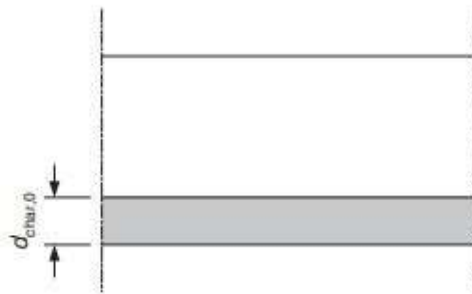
Carbonização unidimensional com exposição ao fogo de um lado [33].
